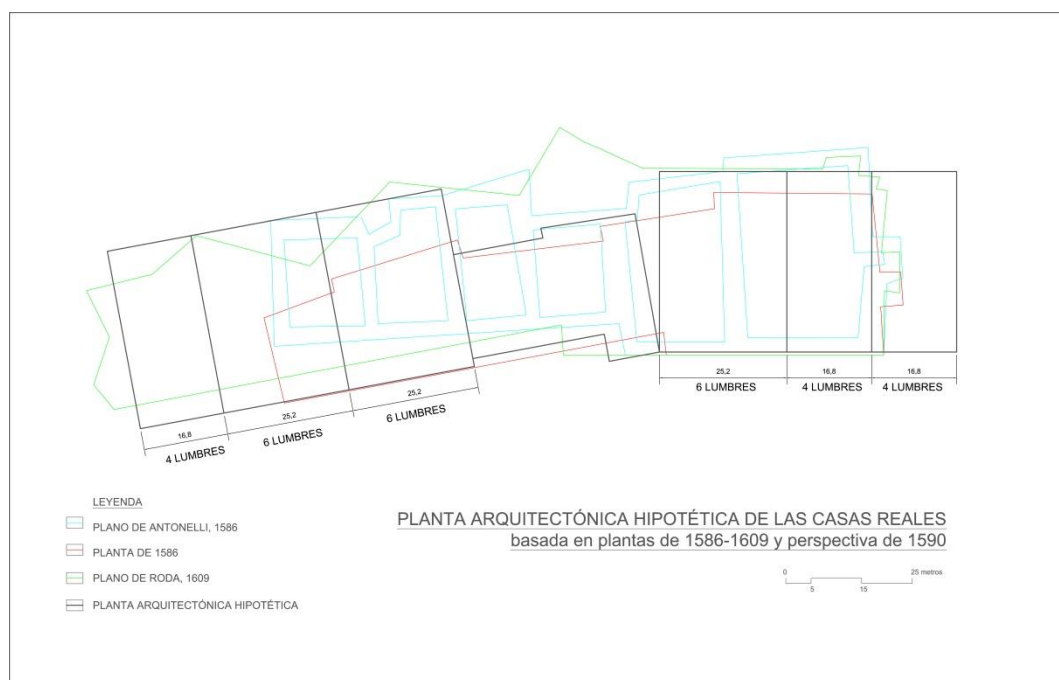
bosquejo esquemático de planta arquitectónica hipotética del conjunto superpuesta a las plantas de Antonelli, 1586 y Roda (Silvia Arroyo). Ver anexo 5.
